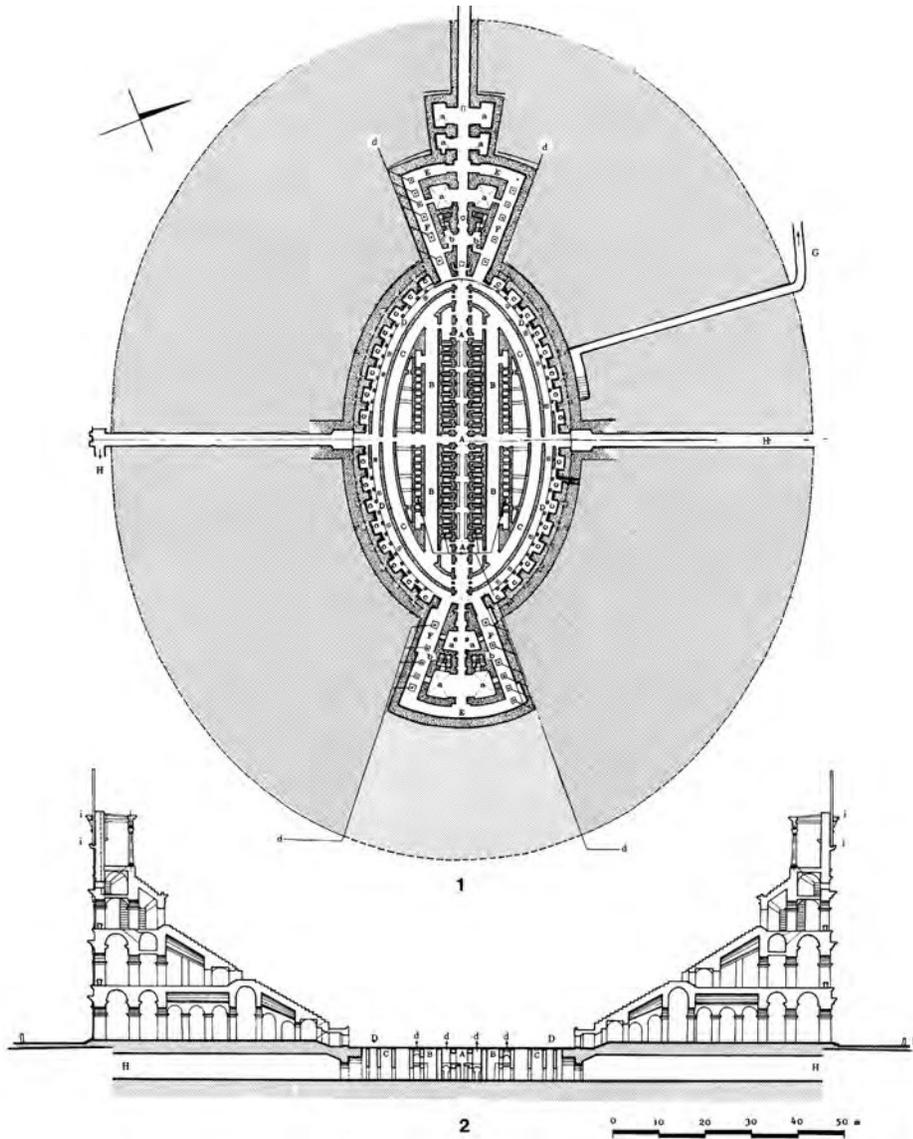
Rom, Kolosseum, Grundriss, Untergeschoss
